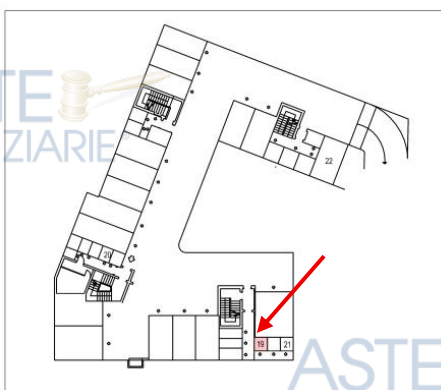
Individuazione della collocazione della cantina del subalterno 19 sulla planimetria del piano interrato
